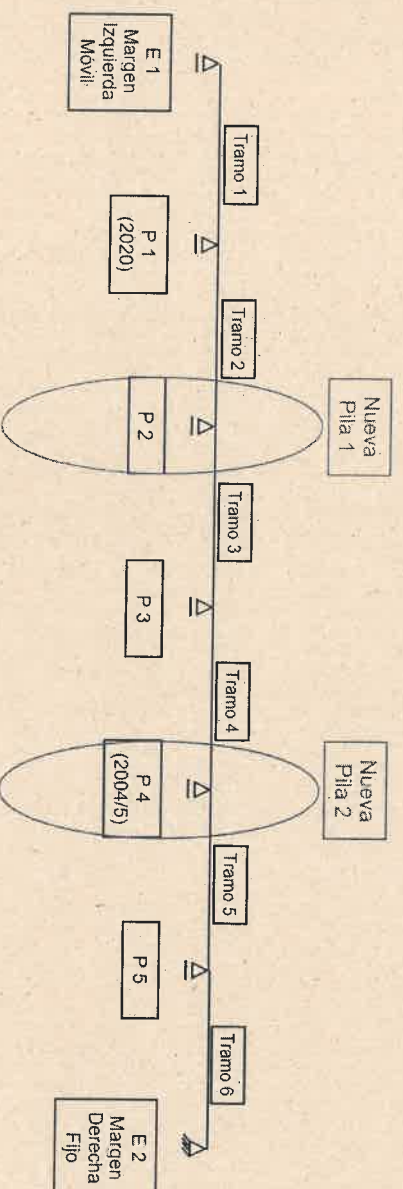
Esquema Estático de Puente Demolido y Emplazamiento de Pilas Nuevas con tres Tramos Iguales
